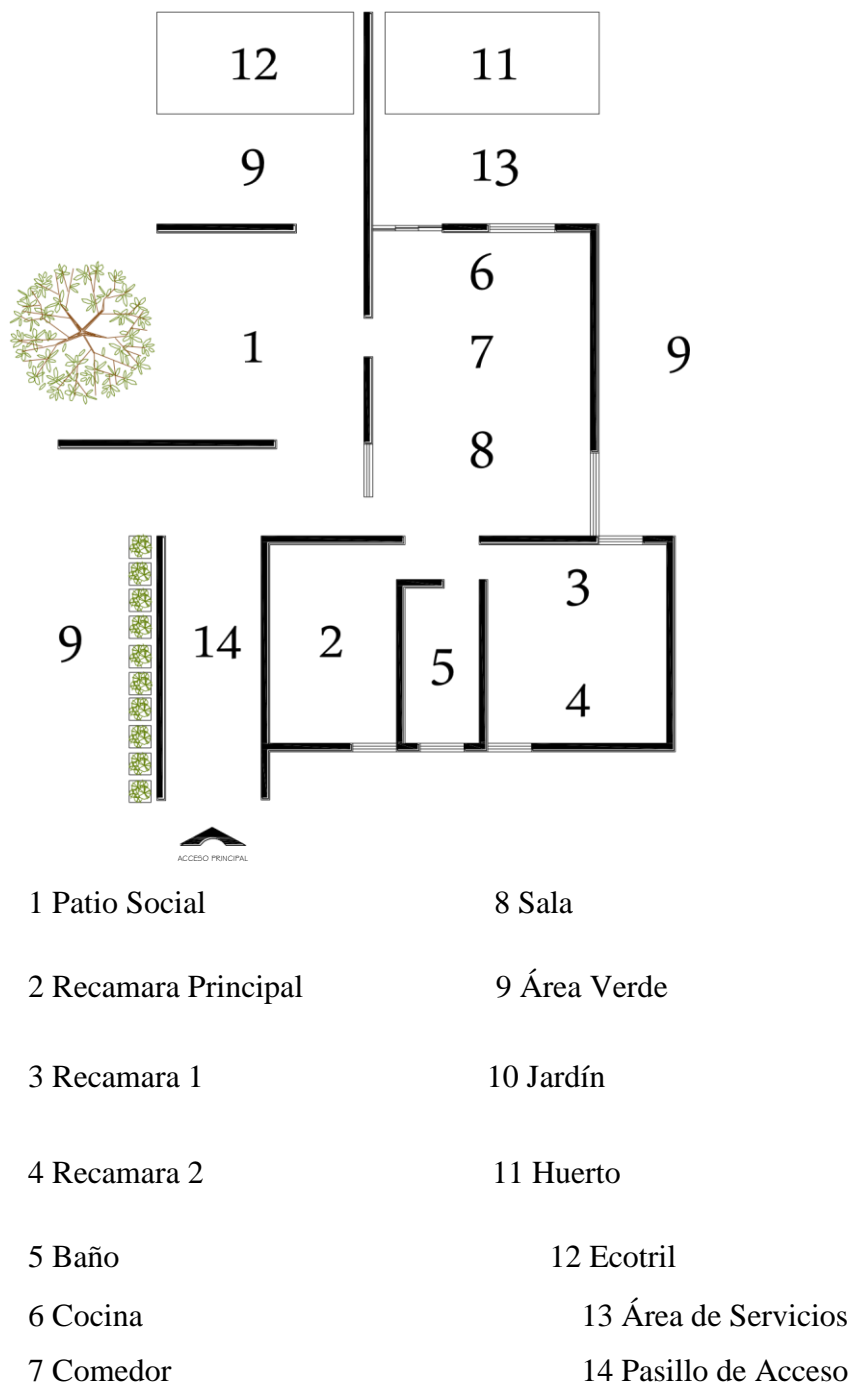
Propuesta de planta arquitectónica. Autoría Propia
